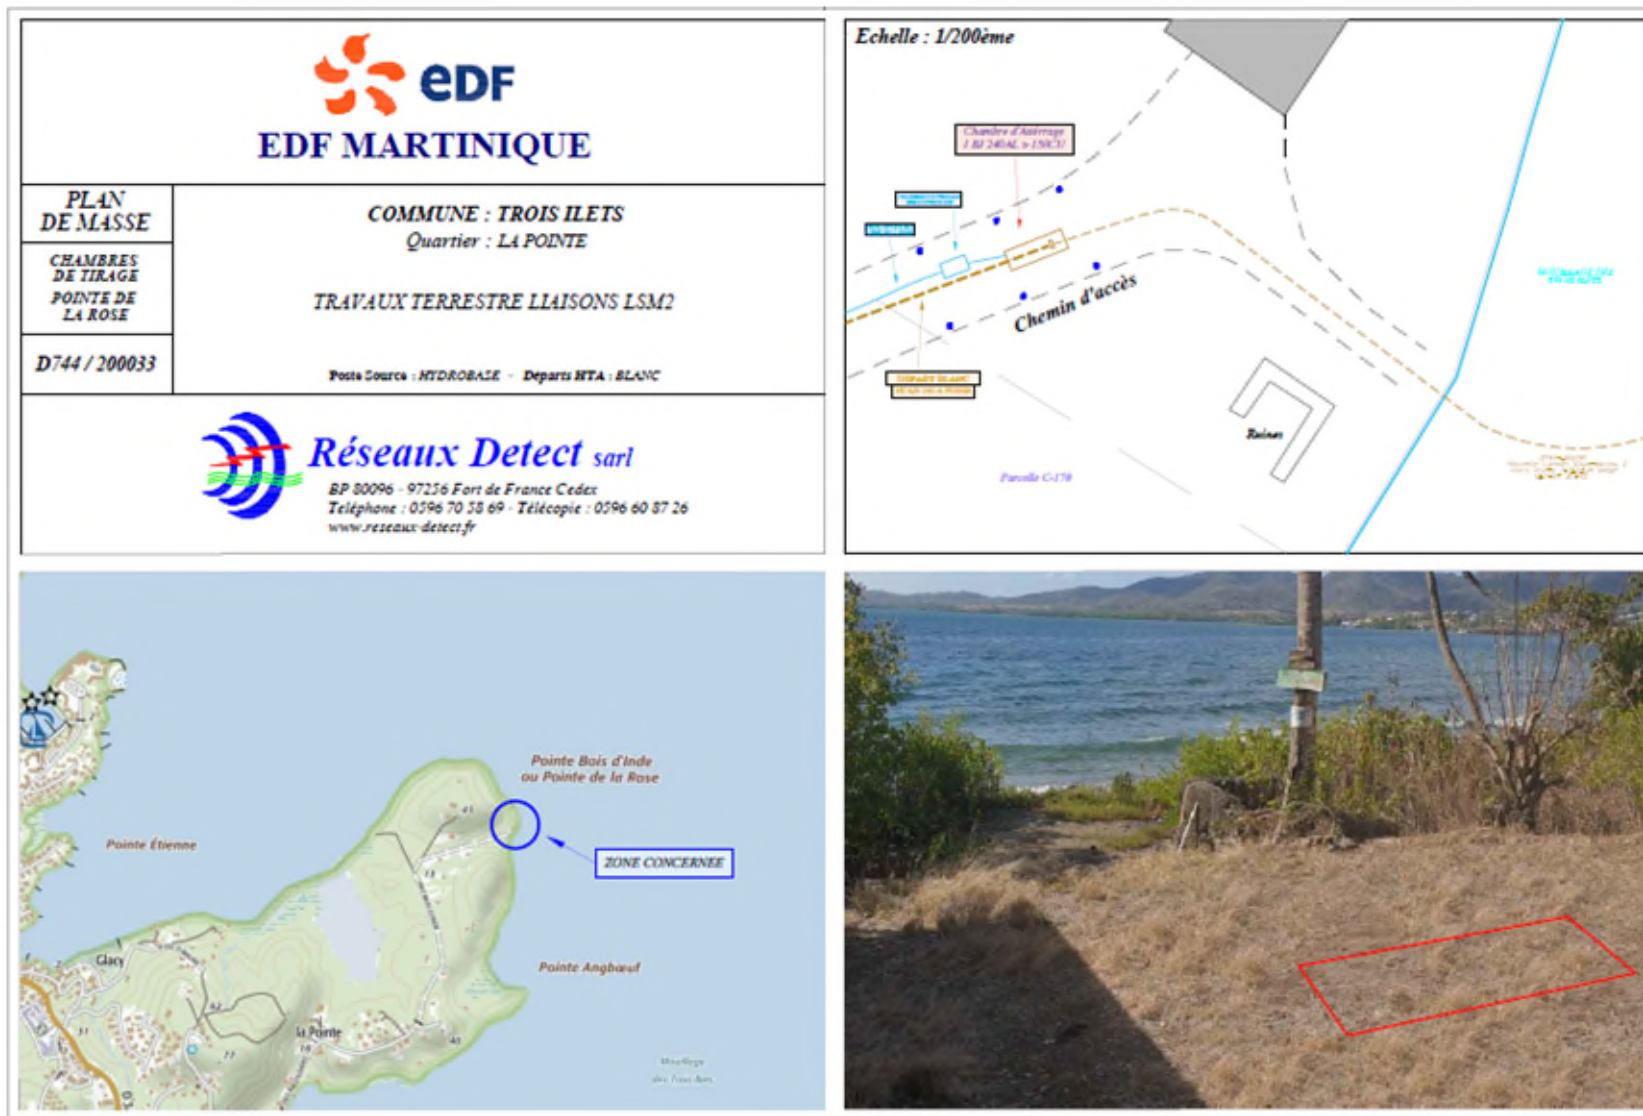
PLAN DE SITUATION ATERRAGES TROIS-ÎLETS
